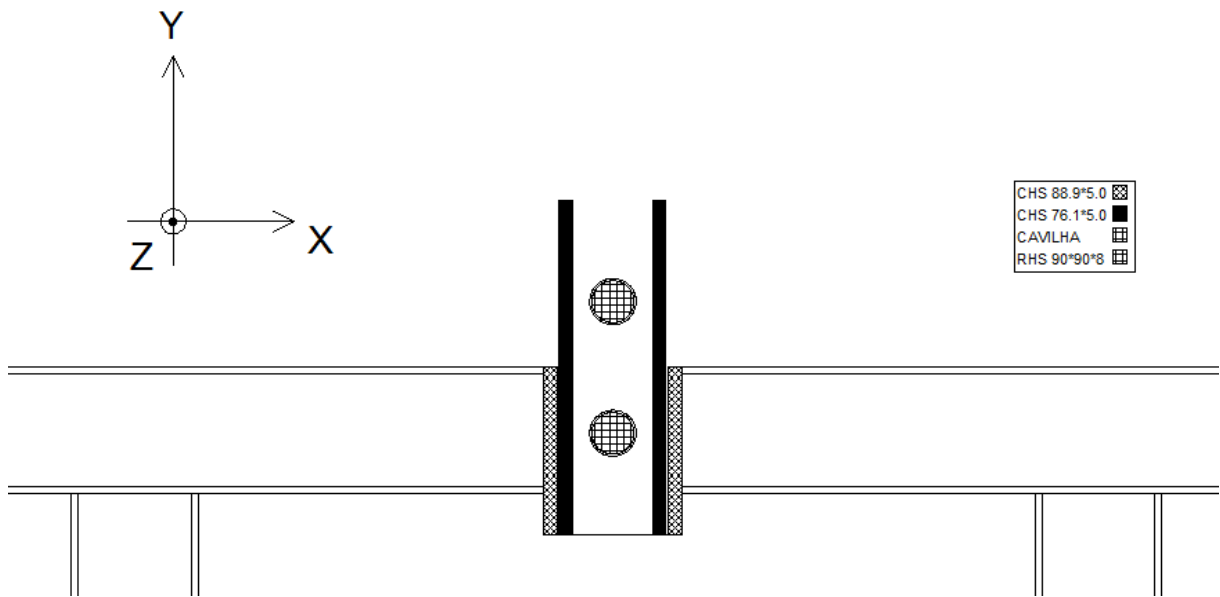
Modelo de cálculo para o dimensionamento do cordão de soldadura, parte 1
